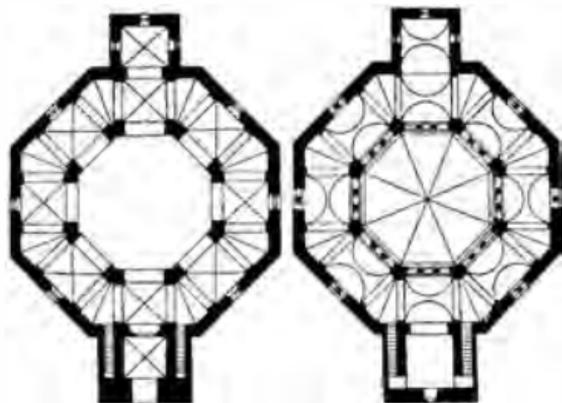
Piante di chiese: la pianta centrale e la pianta basilicale.
